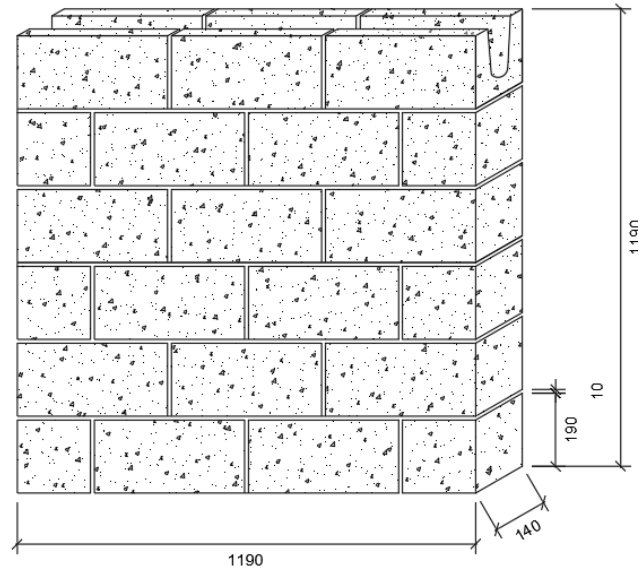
Miniparede com viga, dimensões em mm. Fonte: Próprio autor
